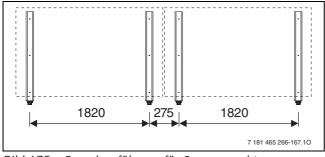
Grundausführung für 2 waagerechte Kollektoren
